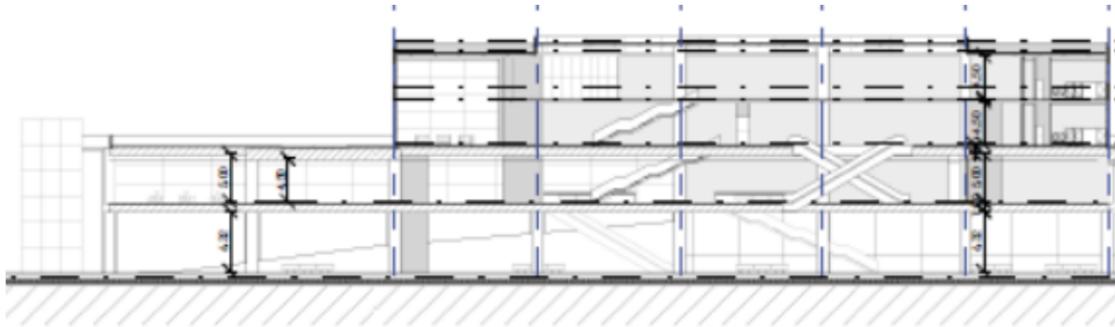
Sección longitudinal, se aprecia la prolongación de la planta sótano respecto a la planta baja.
